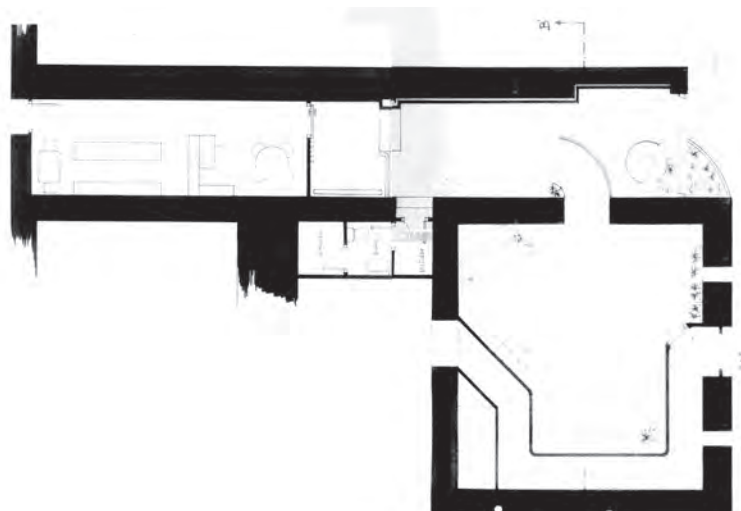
20. PLANTA DE LOCAL DE LA PLANTA BAJA ¹¹
